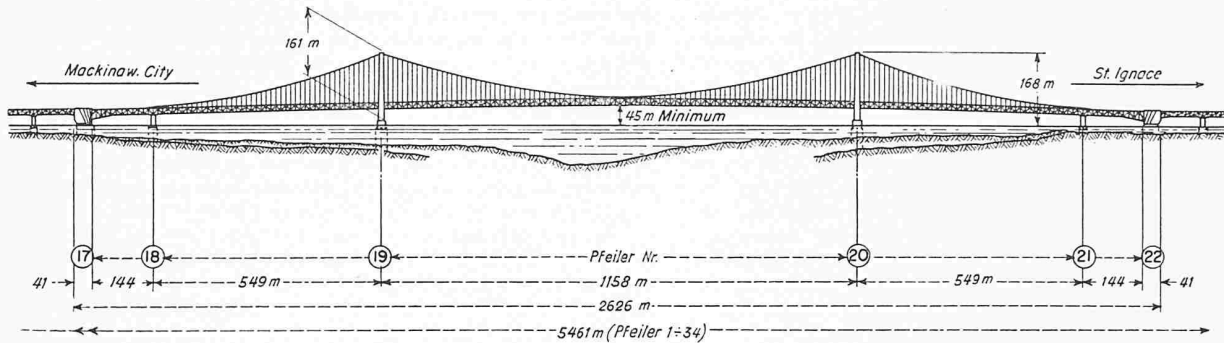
Die Mackinac-Hängebrücke, Masstab 1:17 800
